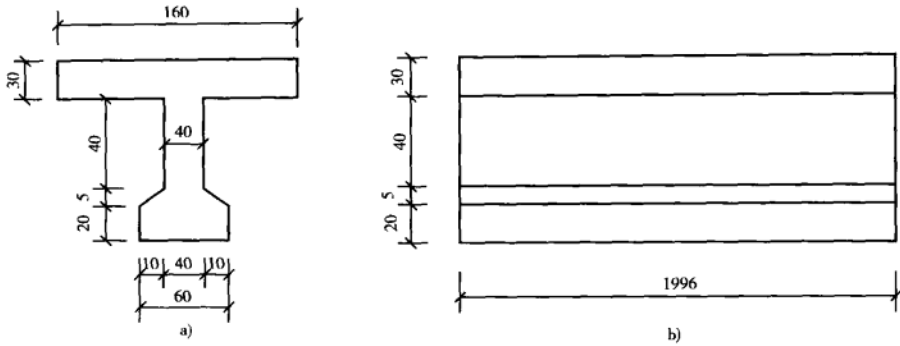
T形预应力混凝土预制梁示意图 (单位:cm)
